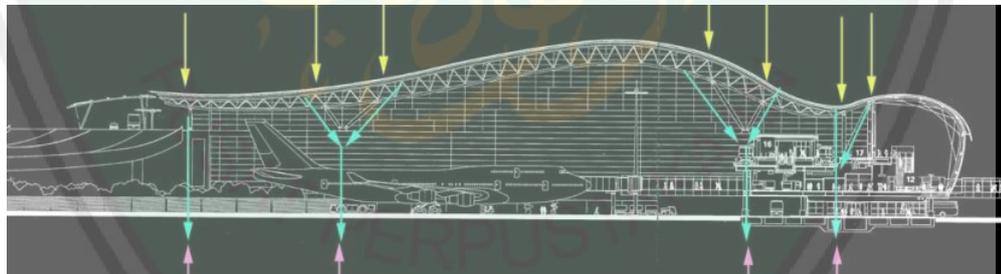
Potongan Bandara Internasional Kansai, Jepang (Arch: Renzo Piano Building Workshop)
